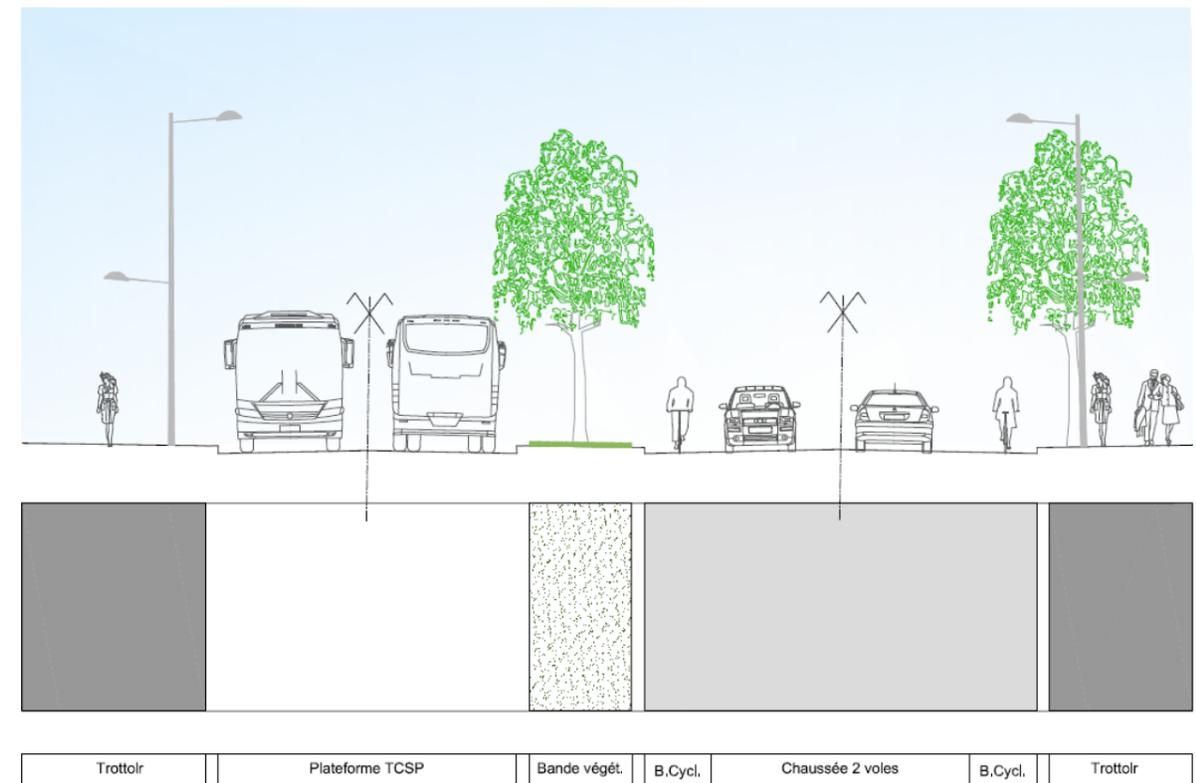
Coupe de principe sur le Boulevard Nord - Section 1
